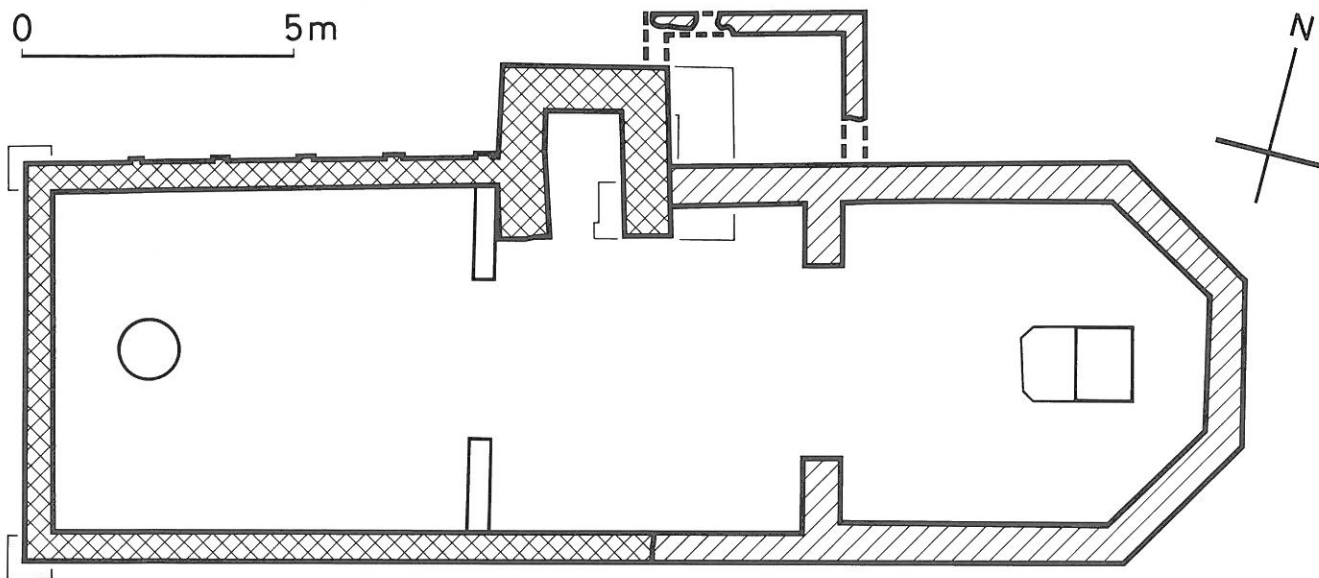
Grundriss der Anlage V. M. 1:140
